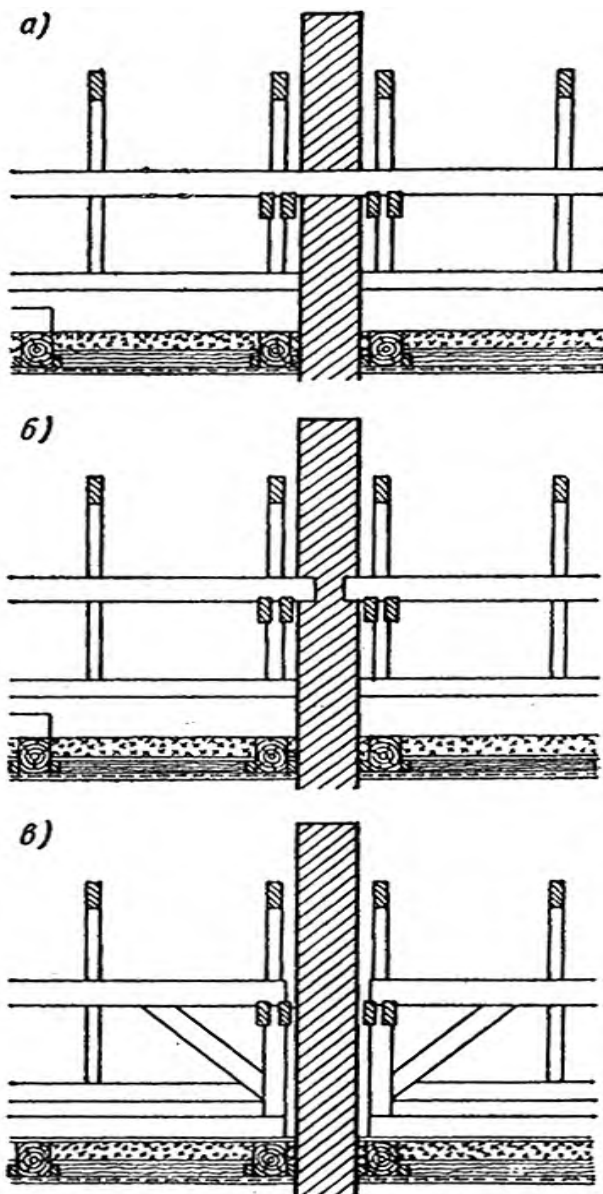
Сопряжение деревянных конструкций крыши с противопожарной стеной: а – неправильное (прогон пропущен через противопожарную стену); б – неправильное (прогоны опираются на гнезда в противопожарной стене); в – правильное (прогоны опираются на подкосы и стойки)
